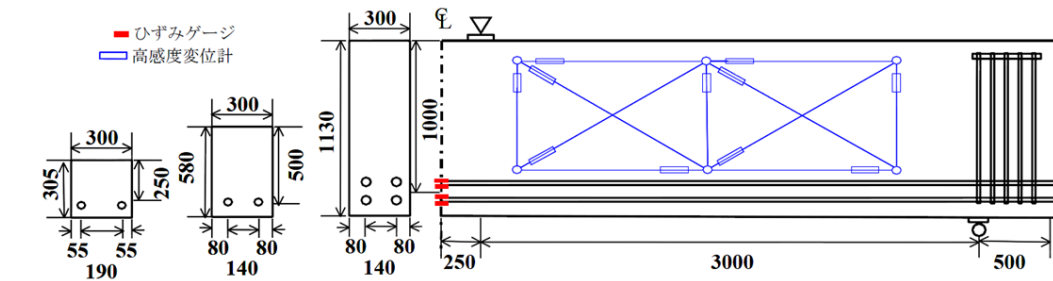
RC はり試験体の概要 (単位 mm)³⁾
